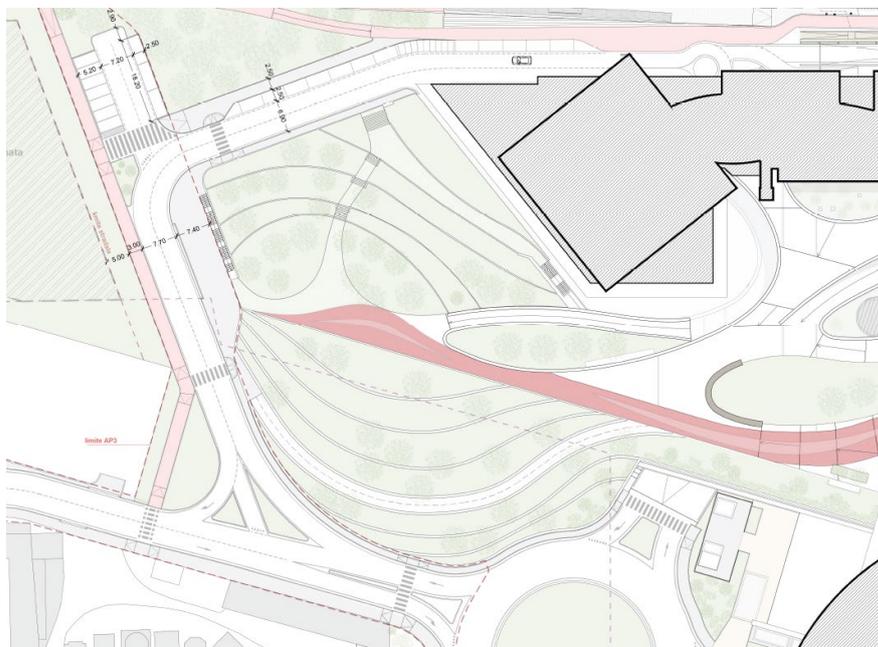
NUOVO COLLEGAMENTO COLLINA
